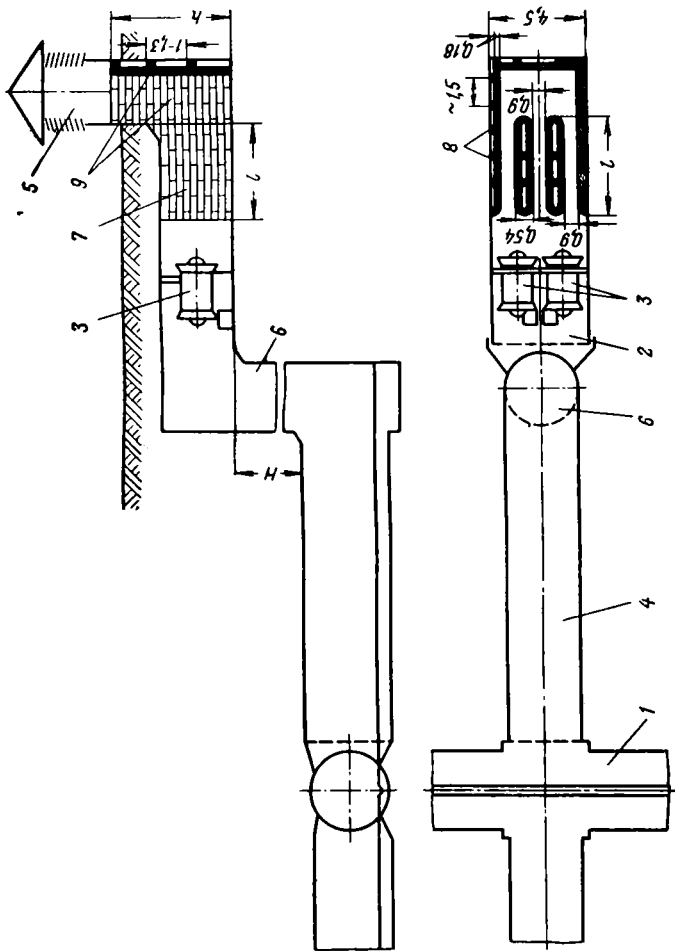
Схема размещения пластинчатых глушителей шума из бетонных шумопоглощающих блоков в вентиляционной установке тоннельной вентиляции, расположенной у поверхности земли сбоку перегона глубокого заложения метрополитена:
